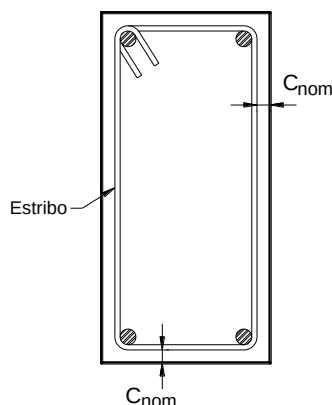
Espessura do cobrimento da armadura pelo concreto.
